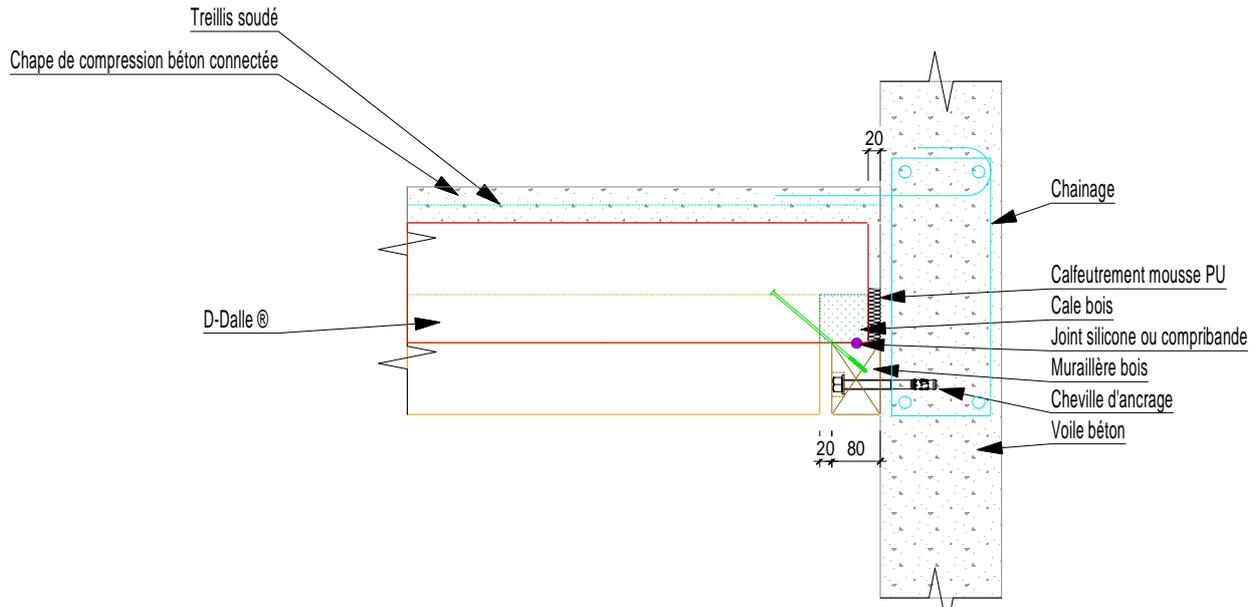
Coupe longitudinale – détail d'appui sur muraillère bois
